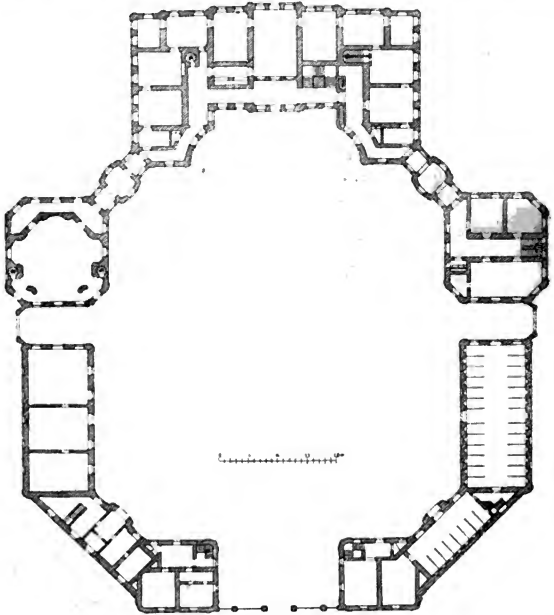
Hofin. Grundriss des Schlosses.
